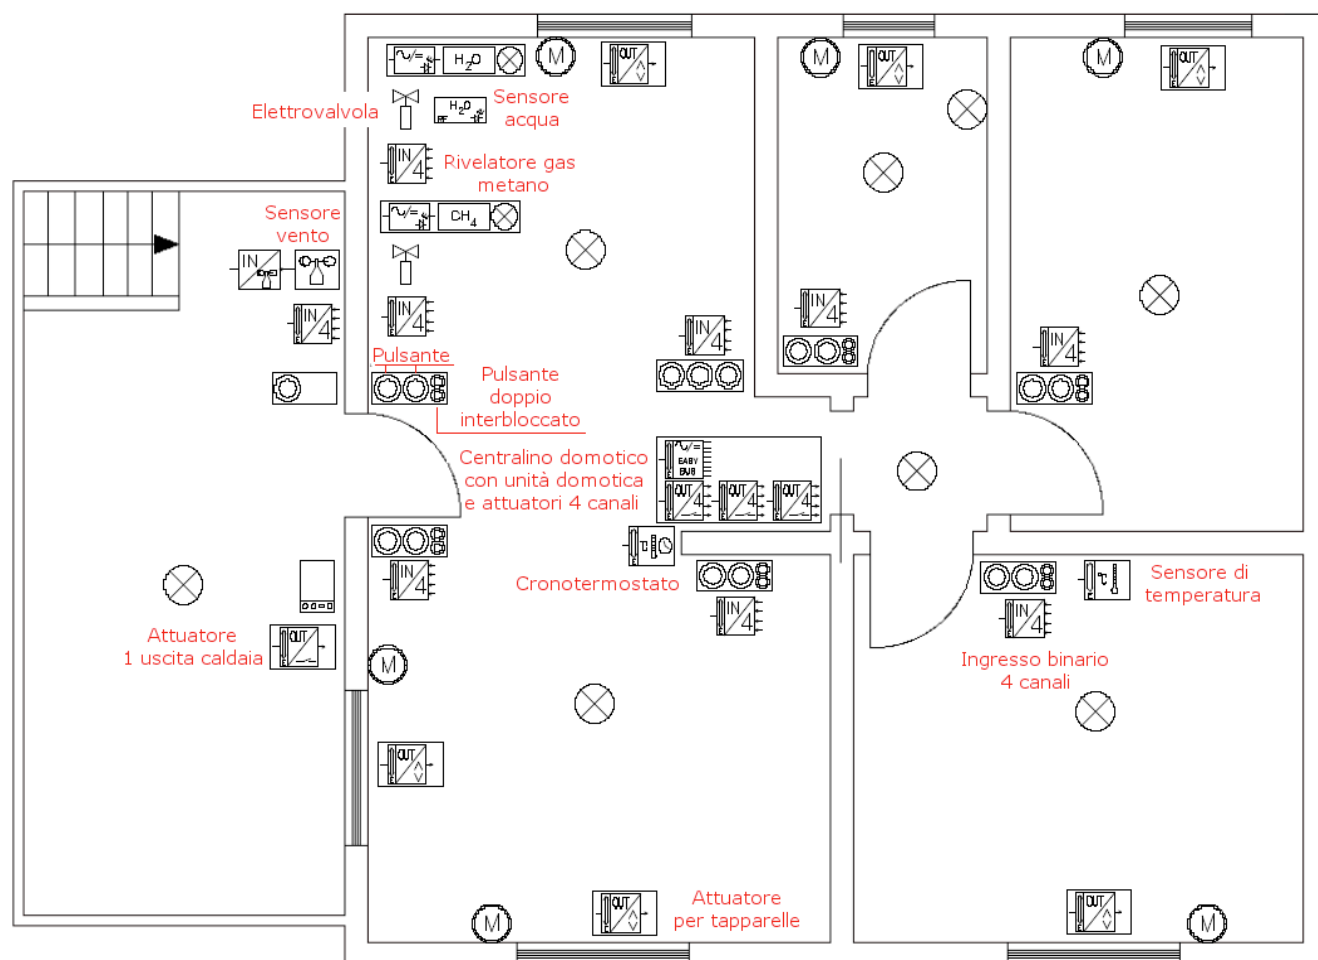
Esempio di planimetria con dislocazione componenti e utilizzatori
